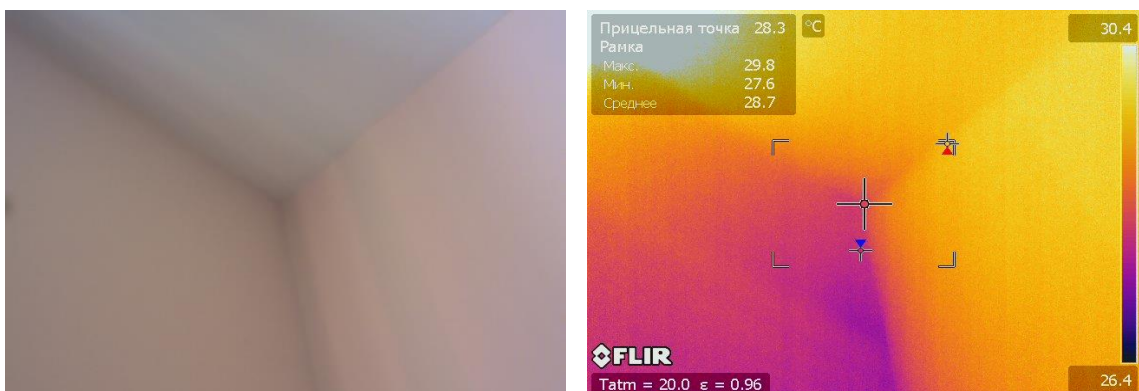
Фрагмент примыкания перегородки и наружной стены
